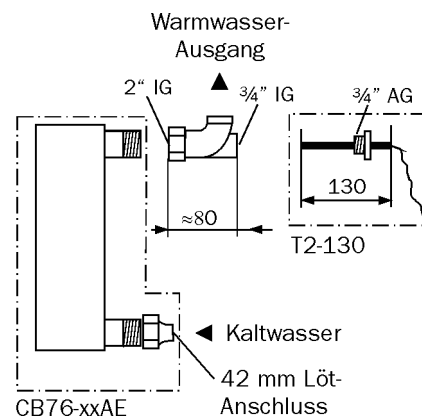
Für größere Rohrdurchmesser: Position des Fühlers T2-130
